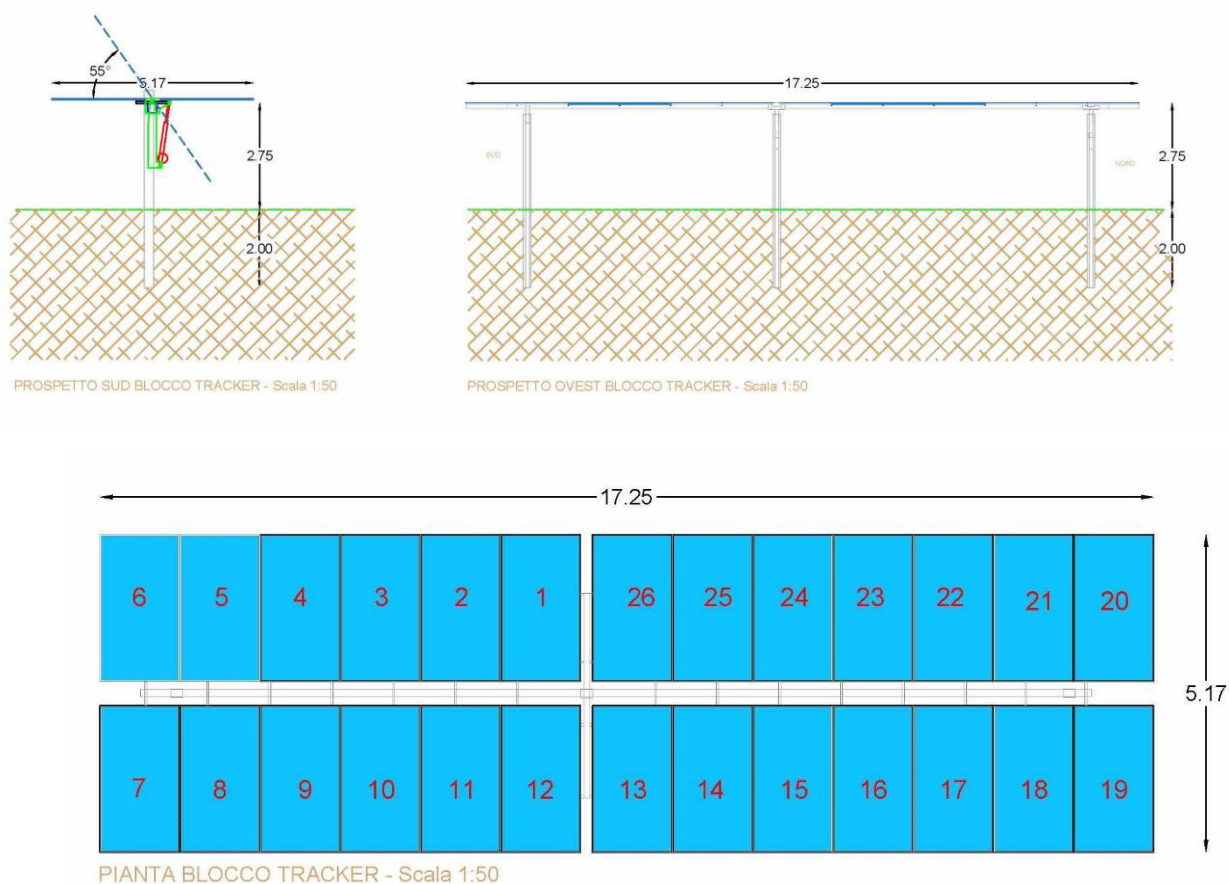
Tipologico struttura sostegno moduli – sezioni e planimetria
